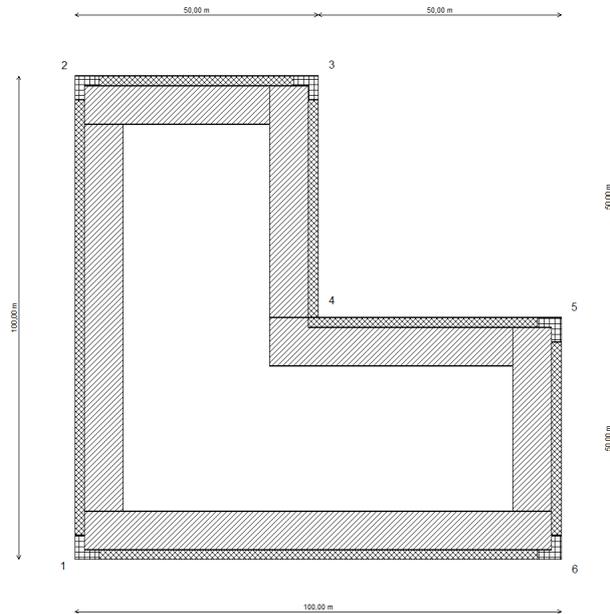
L-förmiger Grundriss (Quelle: MF Windsog)
